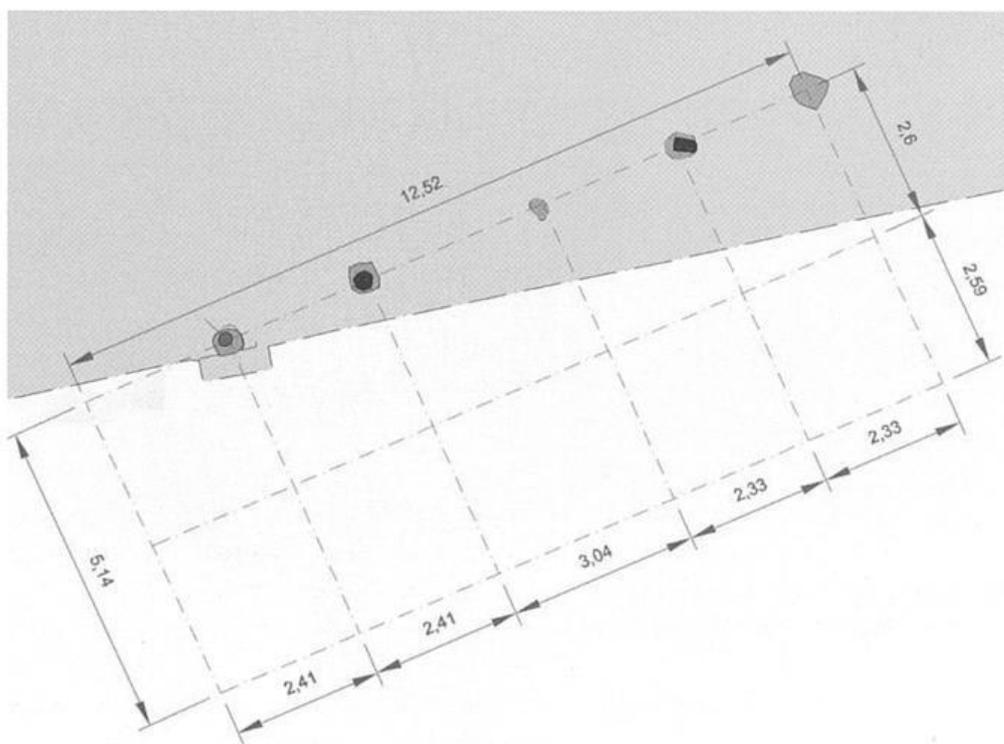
Ausschnitt aus dem Grabungsplan, Grundriss des Speichers 2 mit Maßen und Konstruktionslinien
